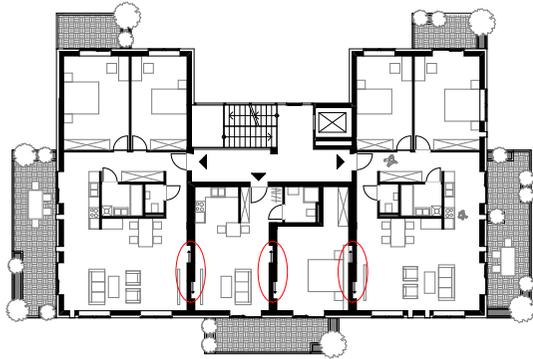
Grundriss - Verschiebbare Wände Situation
